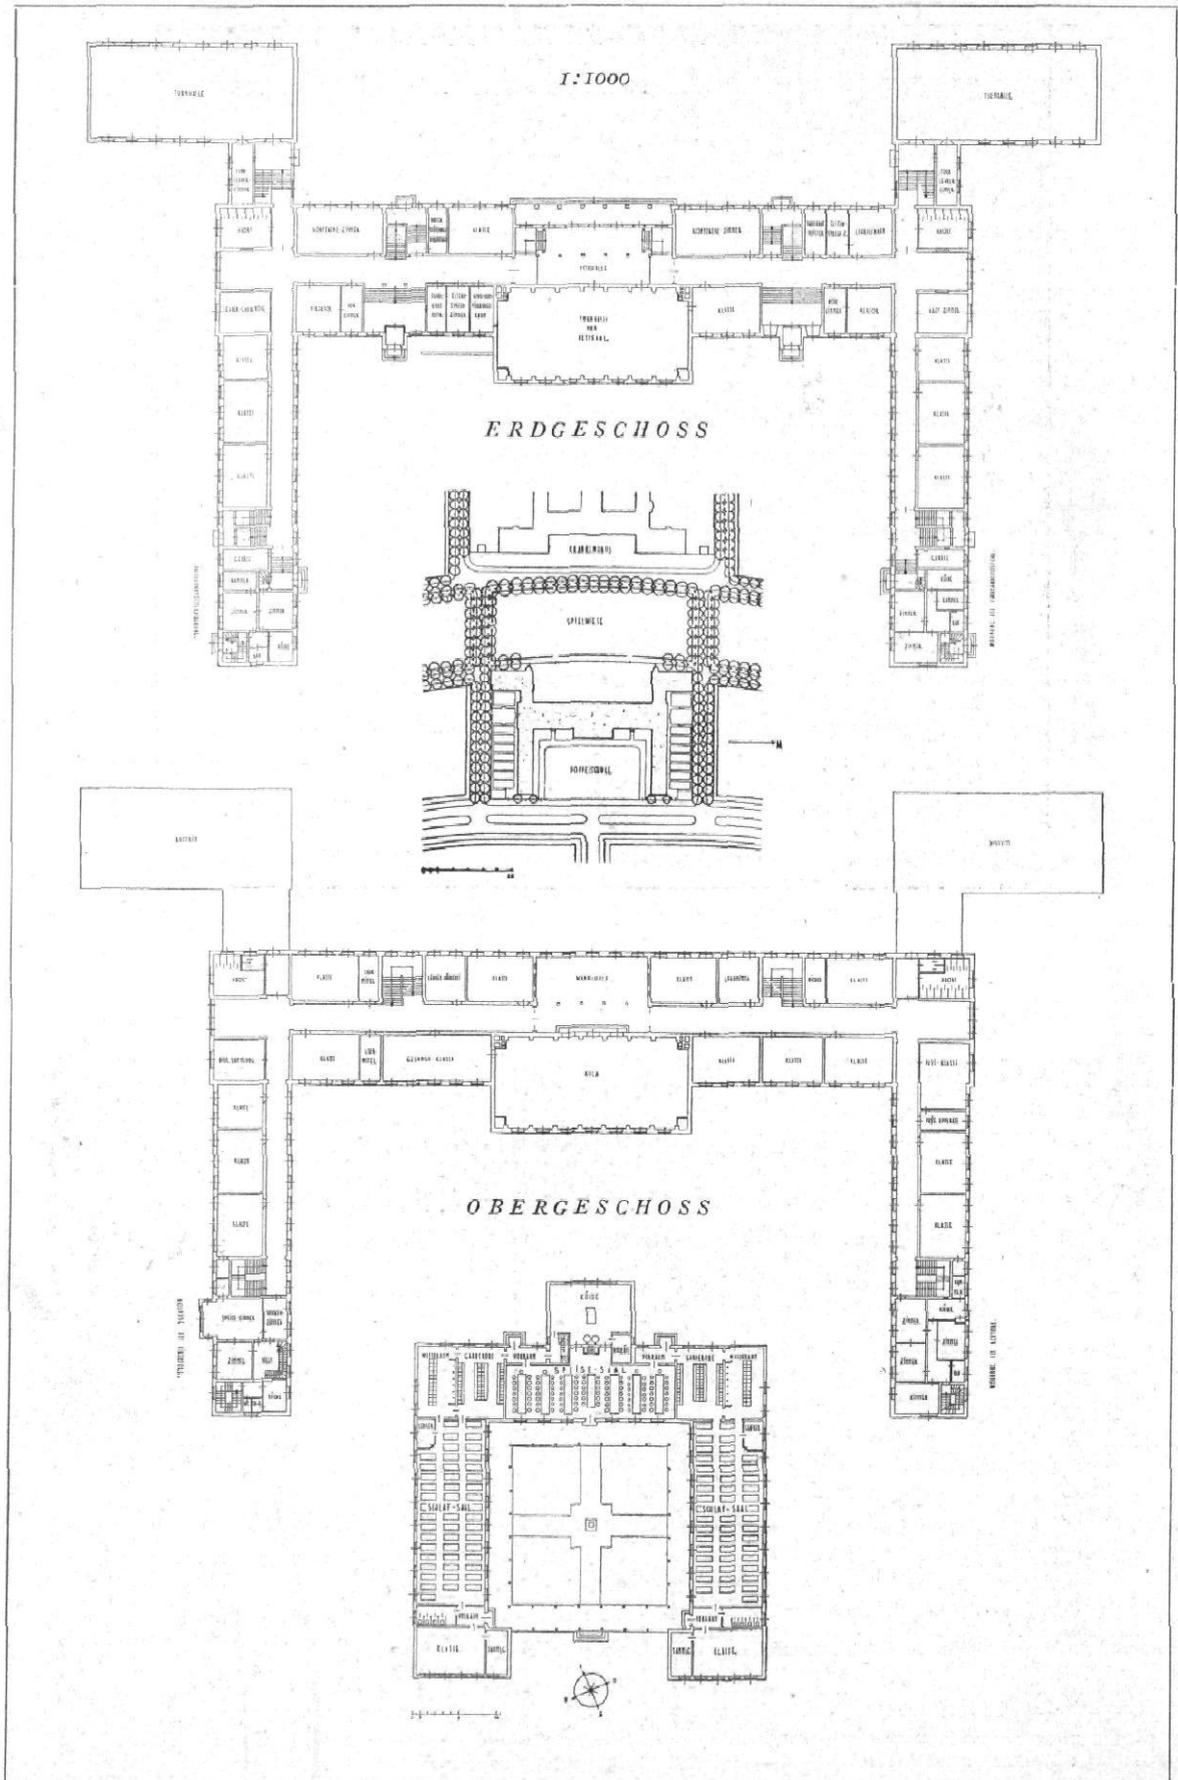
bis 8 / Doppelschule in Berlin-Tempelhof / Grundrisse 1:1000 und Lageplan 1:5000
